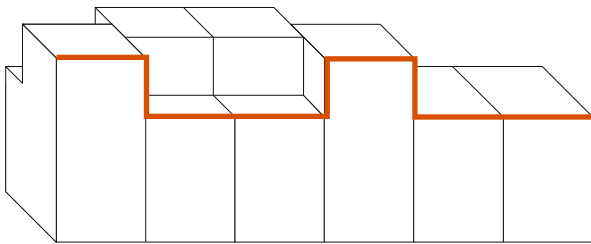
Staffelgeschosse können als Abweichungen von der BremLBO bündig an die darunterliegende Fassade gesetzt werden. Hierdurch können Akzentuierungen ausgebildet werden.
